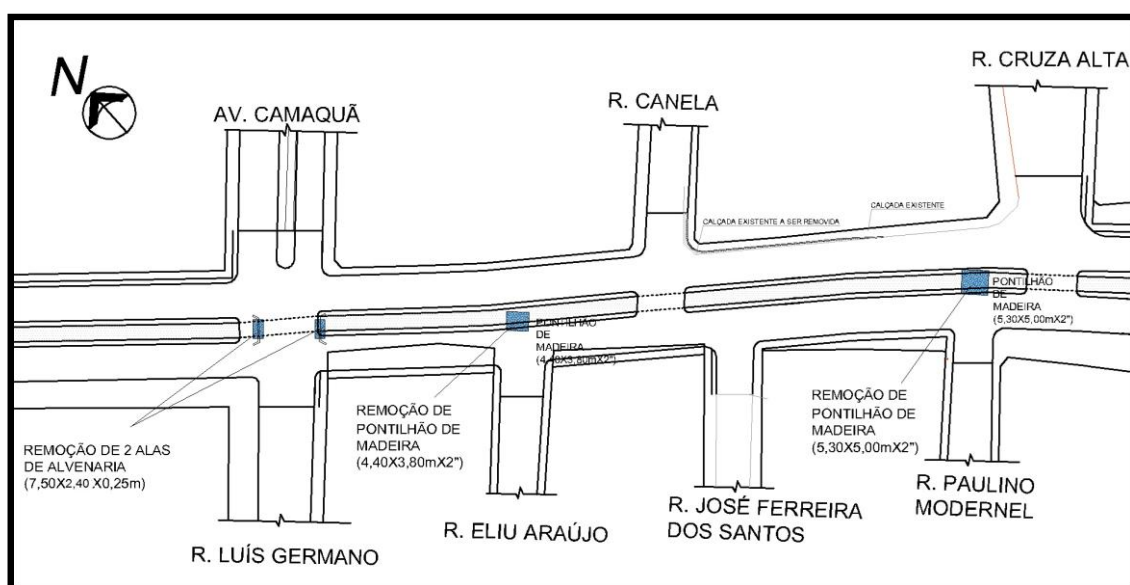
Localização de alas em alvenaria e pontilhões em madeira p/ veículos
